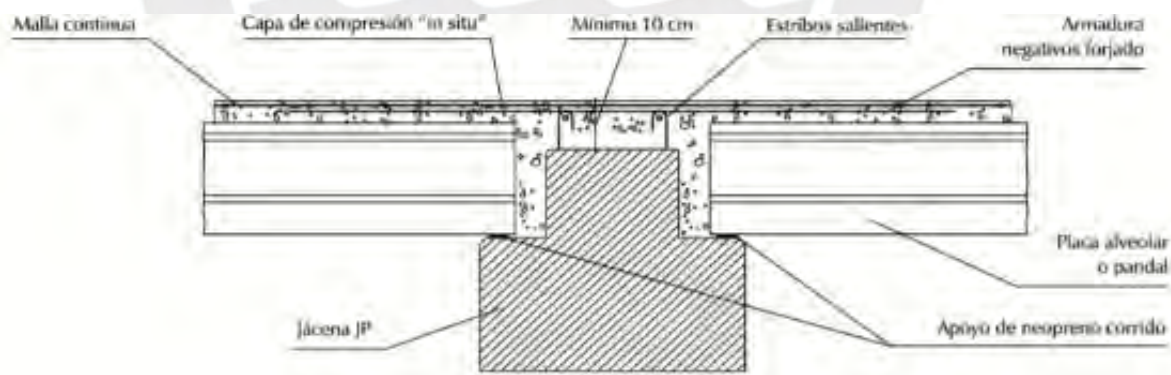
Conexión en viga-losa (Prainsa, 2018)
